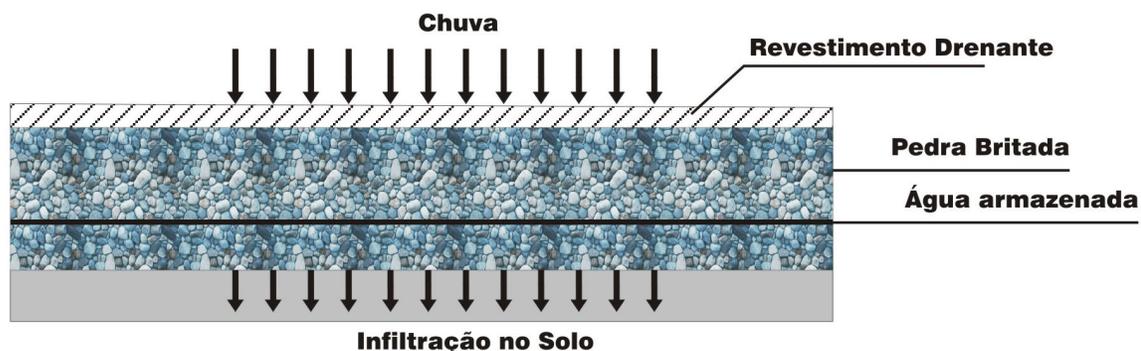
Pavimento permeável, em que a água infiltrada no revestimento fica retida temporariamente na base constituída por pedra e é gradativamente infiltrada no sub-leito.
